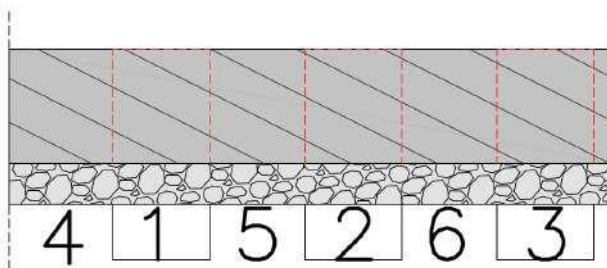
Sección zapata corrida. Refuerzo Tipo 4. Fase. Fuente propia
